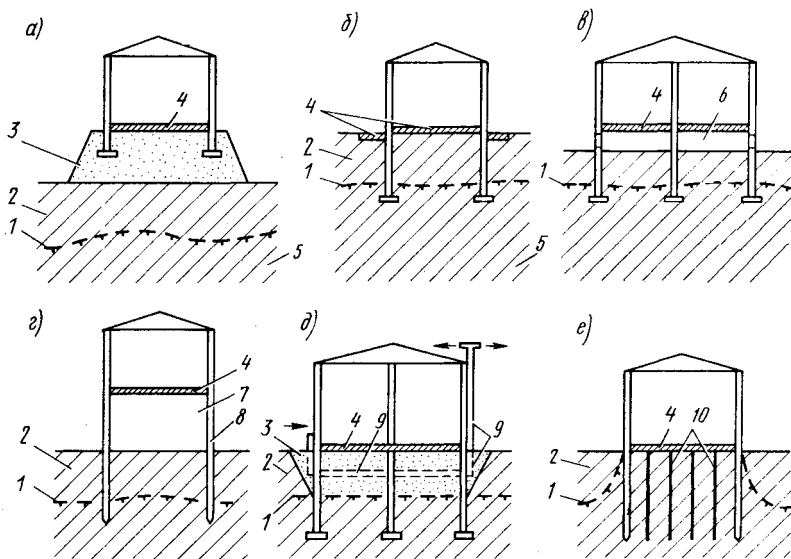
Схемы устройства фундаментов для сохранения в основании вечномерзлого состояния грунтов:
